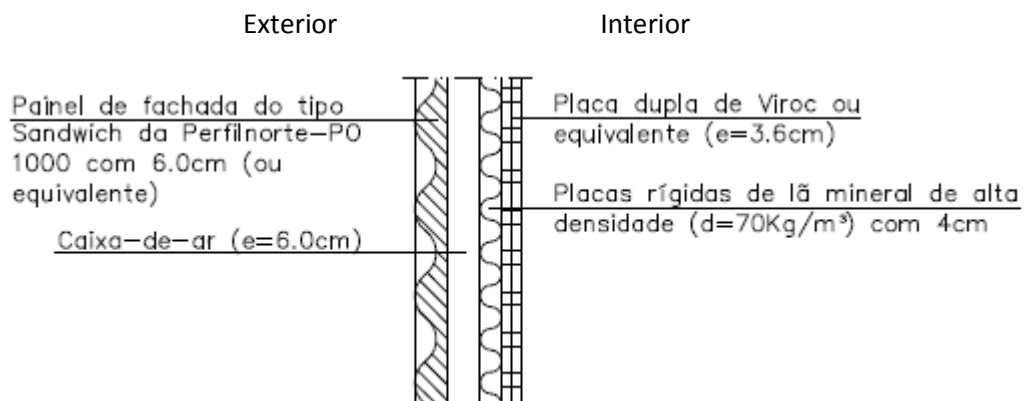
Pormenor construtivo da parede Pe2 [19]
